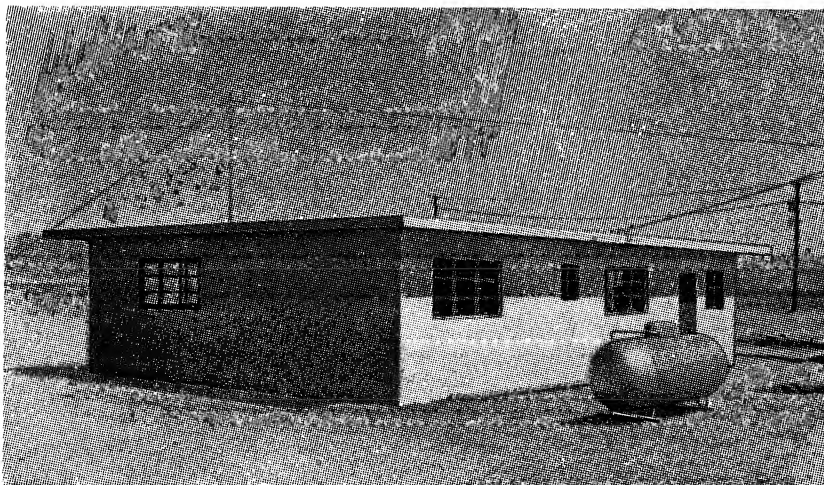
Дом из железобетонных панелей до ядерного взрыва на полигоне в штате Невада
